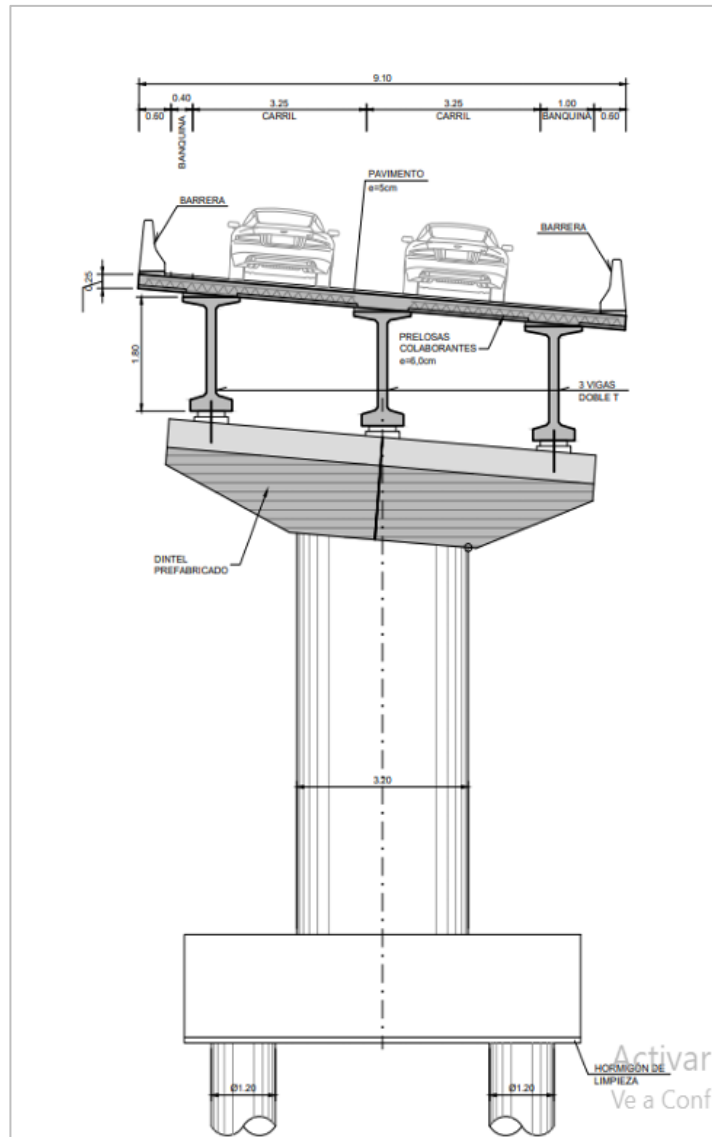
Sección tipo – Estructura (PK 30+449 al PK 30+750).
